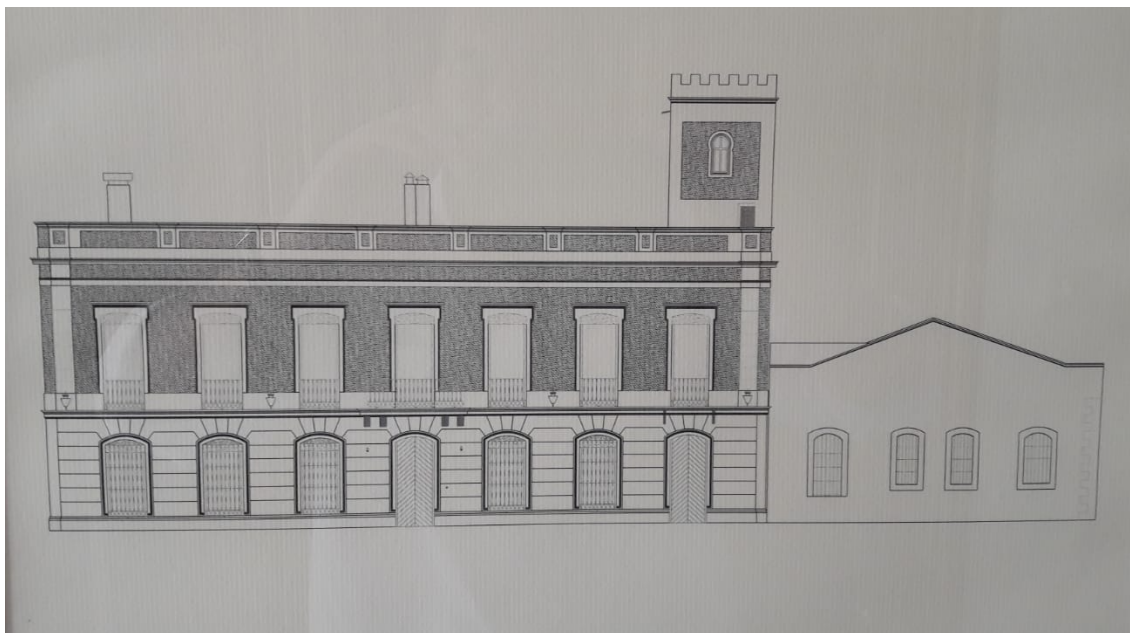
Alzado de la fachada principal de Geraldino. Fuente: Archivo privado de Alfonso Cuesta.
